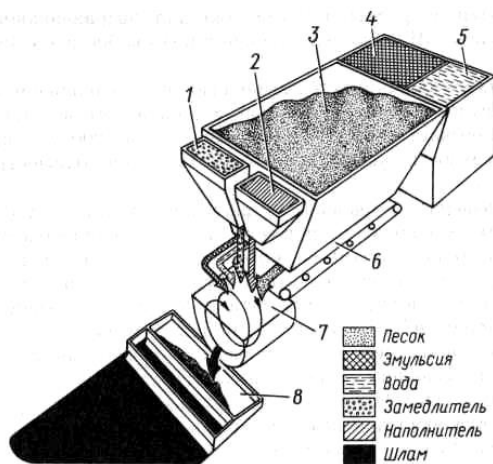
Компоновочная схема машины для приготовления и укладки шлама:
